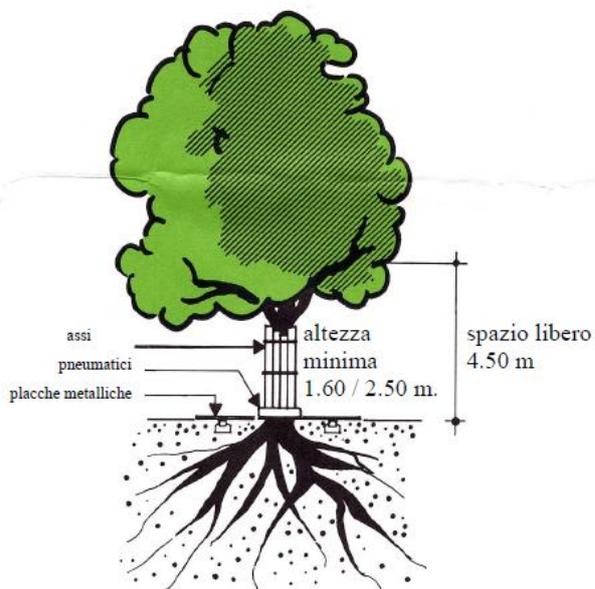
Protezione dell'albero attraverso la delimitazione dell'area minima di rispetto per alberature stradali con poco spazio.
